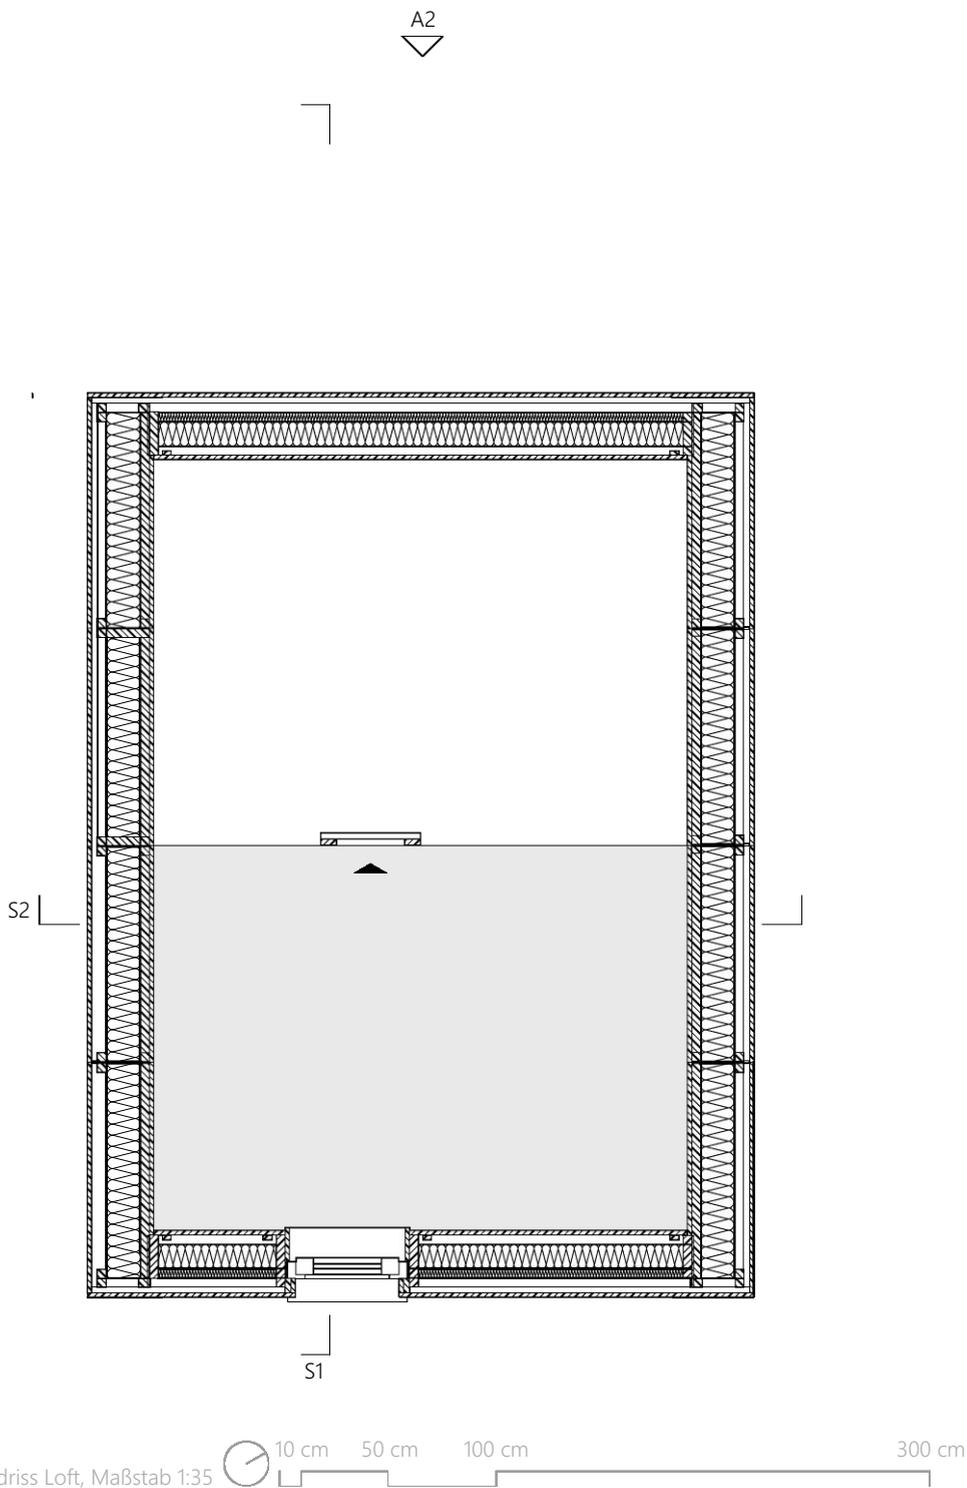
Entwurf Grundriss Loft, Maßstab 1:35
